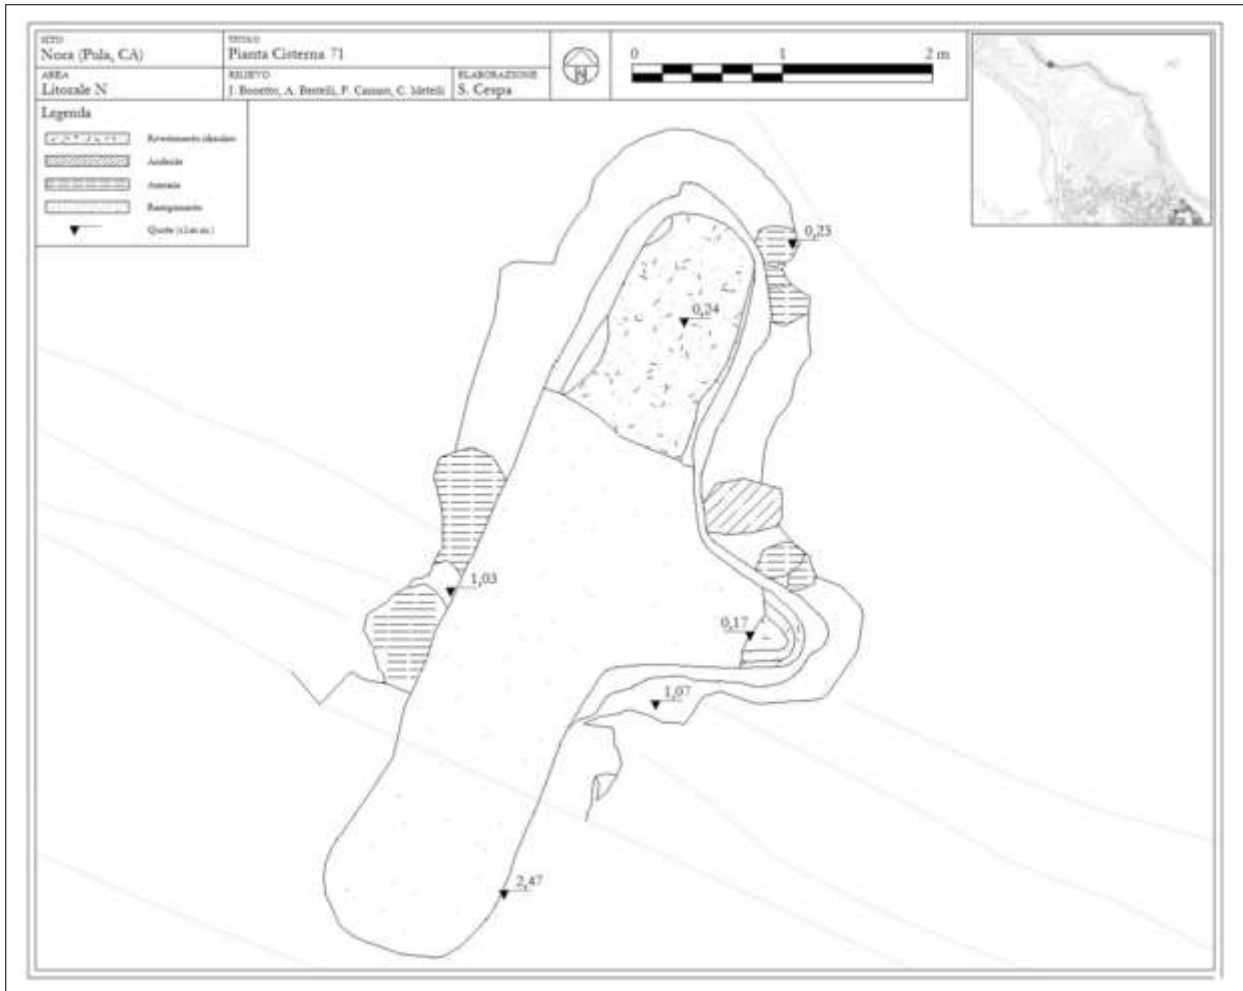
Pianta della cisterna 71 (elaborazione dell'autore).
